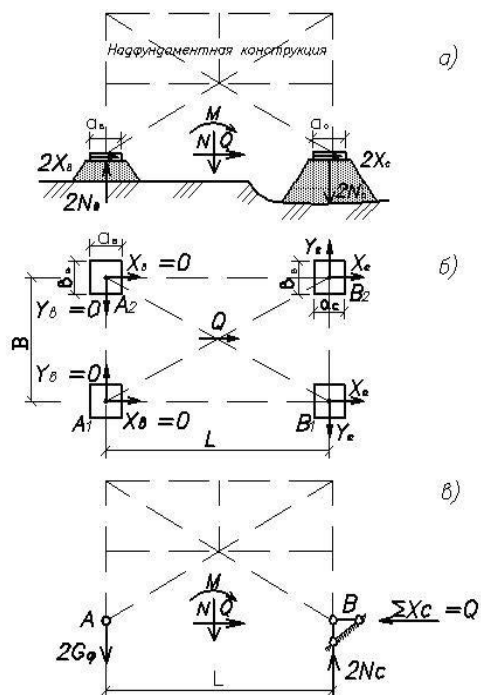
Схемы для статического расчета на опрокидывание сооружения, установленного на поверхностные фундаменты: конструктивная с грунтовыми банкетками (а); то же, вид в плане (б); основная система (в)
